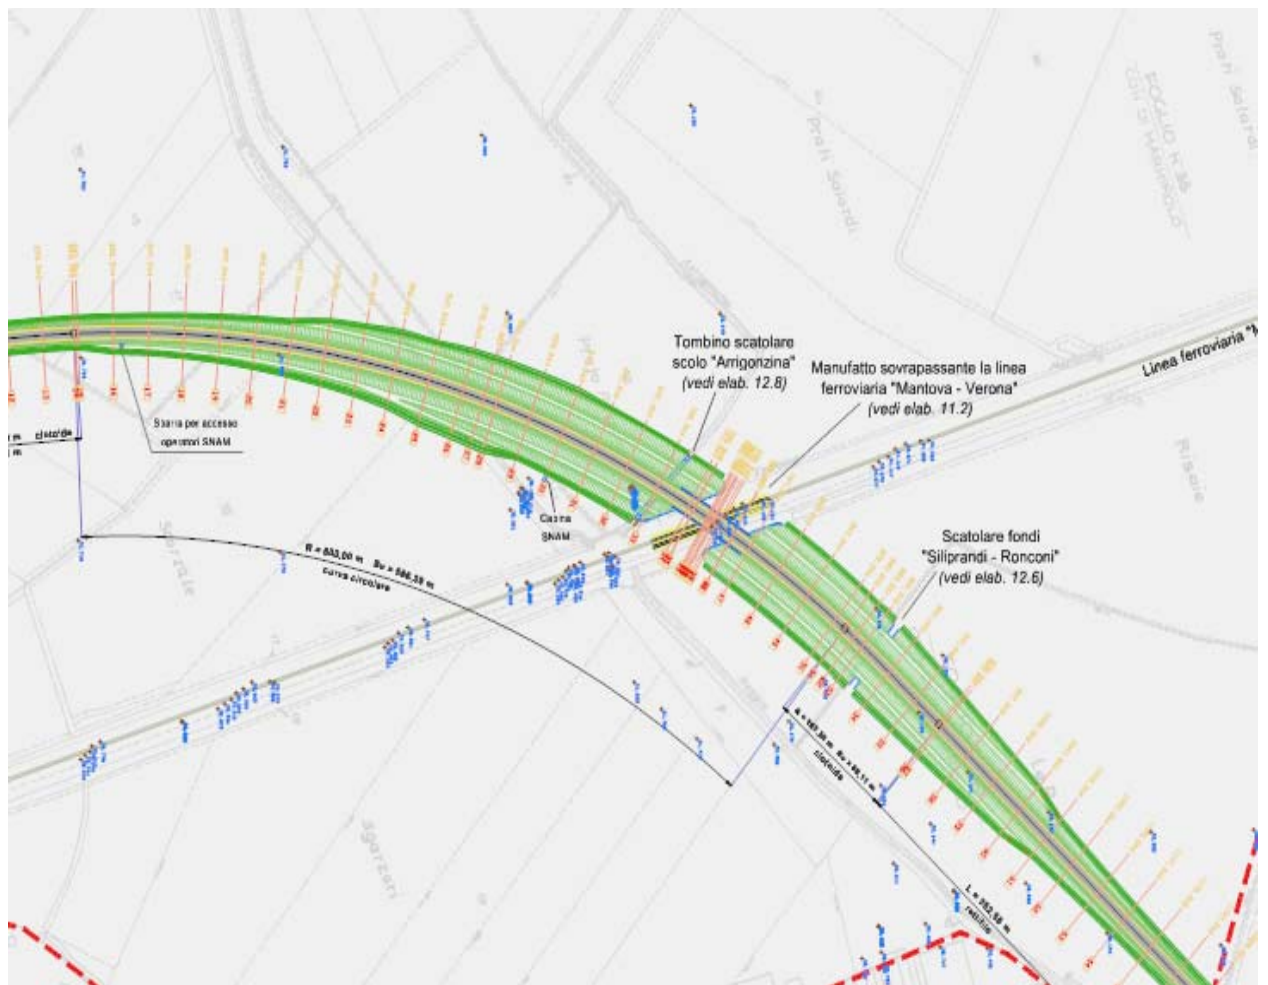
Stralcio planimetrico comprendente il tratto in rilevato
